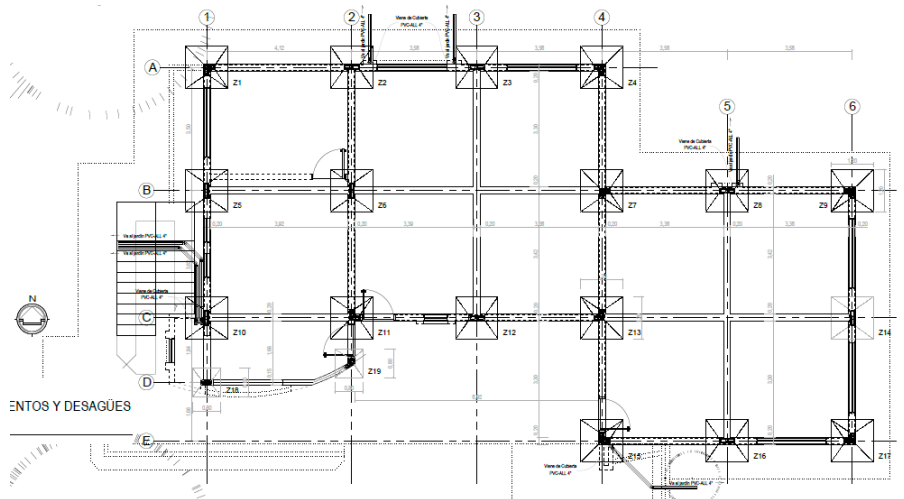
Planta Cimentación Actual Cafamaz.
